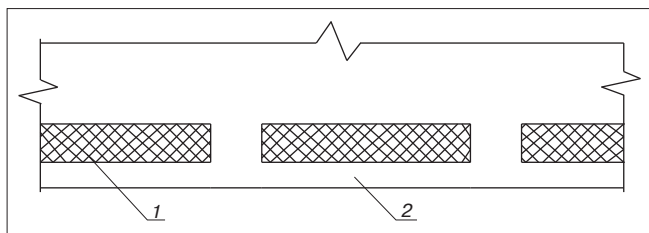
Существующая опорная конструкция: 1 – утеплитель; 2 – опорный железобетонный пояс
